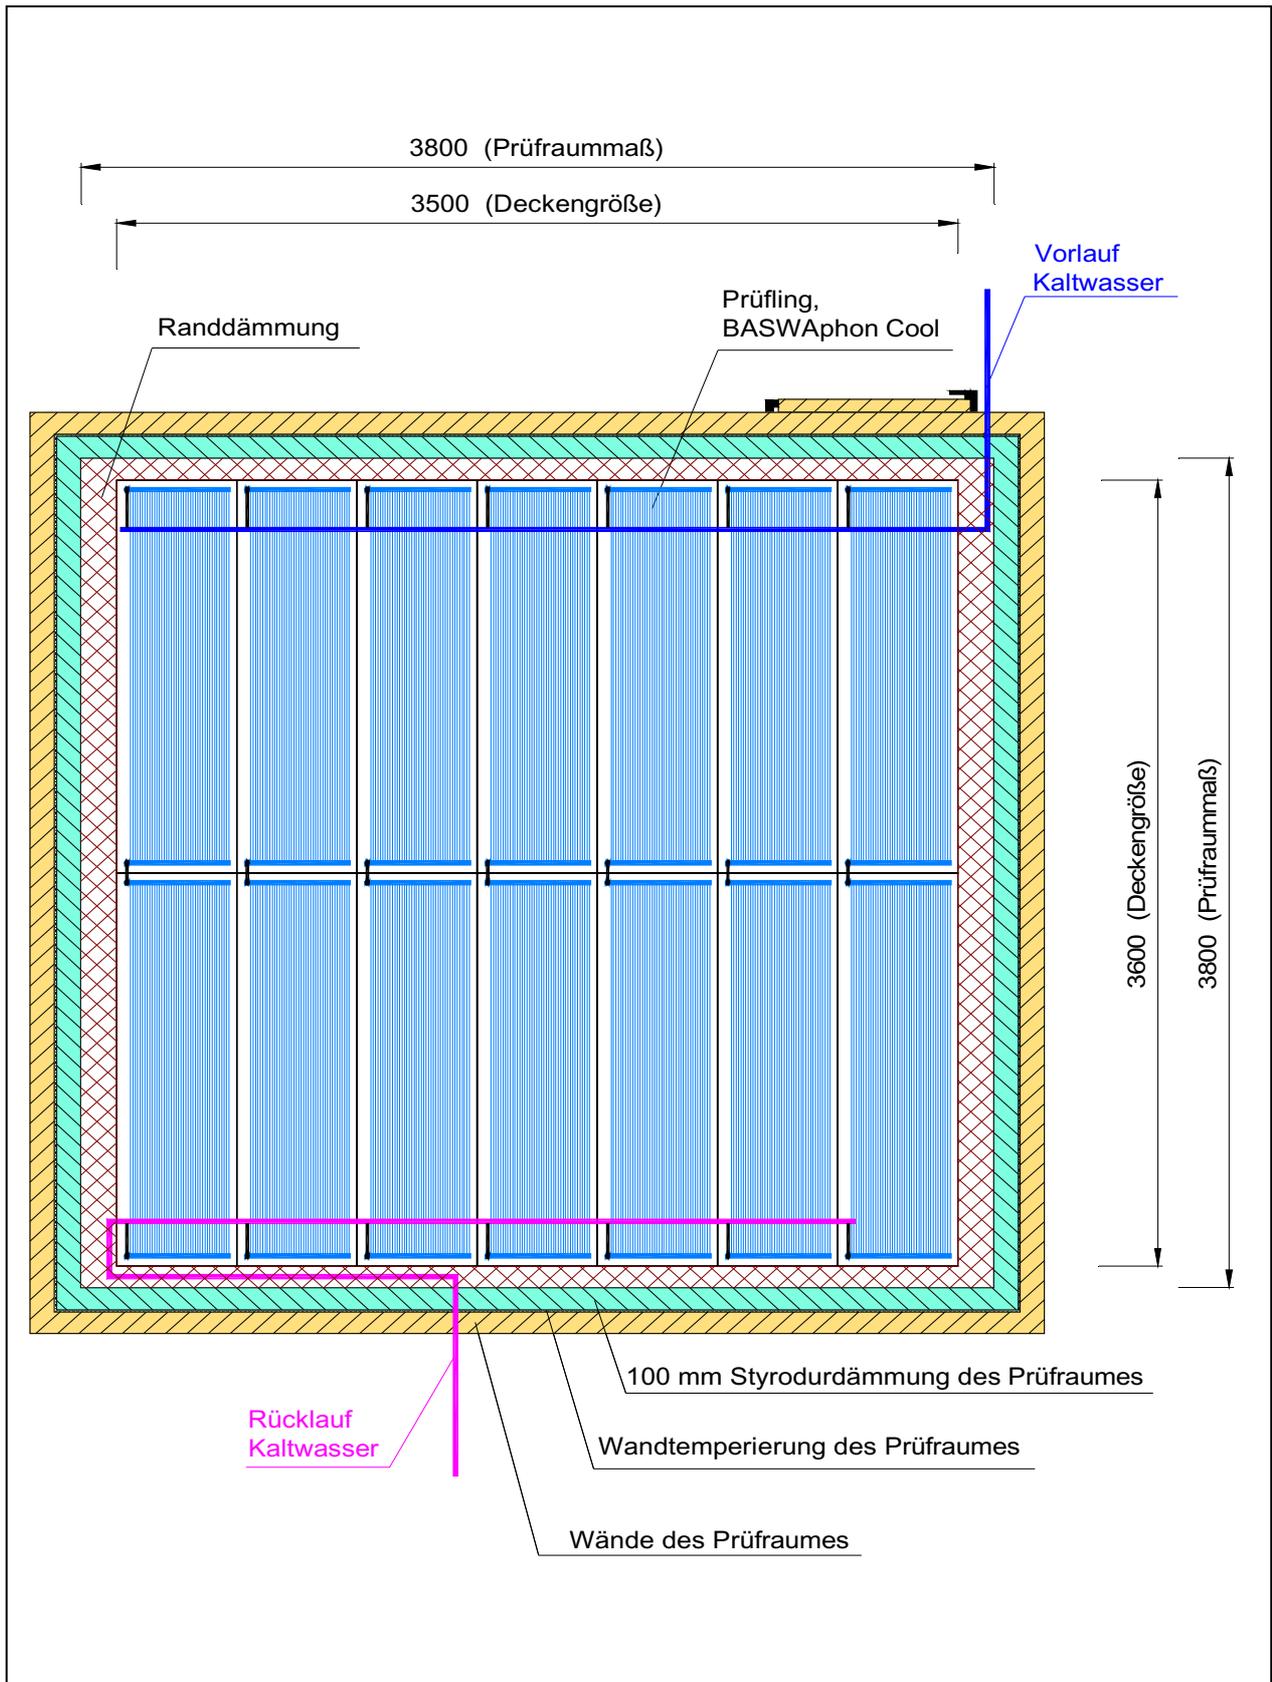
Draufsicht auf den Prüfraum mit der geprüften Kühldecke
